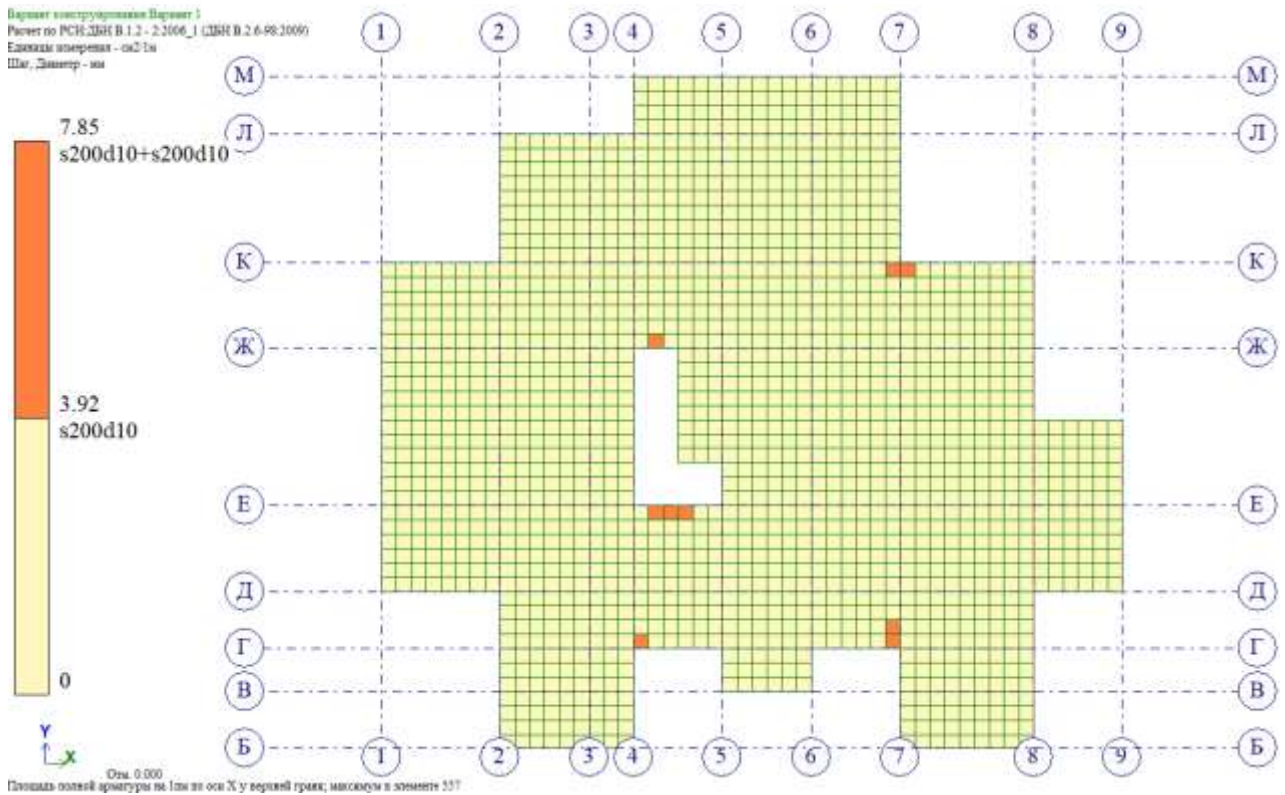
Армування плити перекриття по верхній грані вздовж осі X
